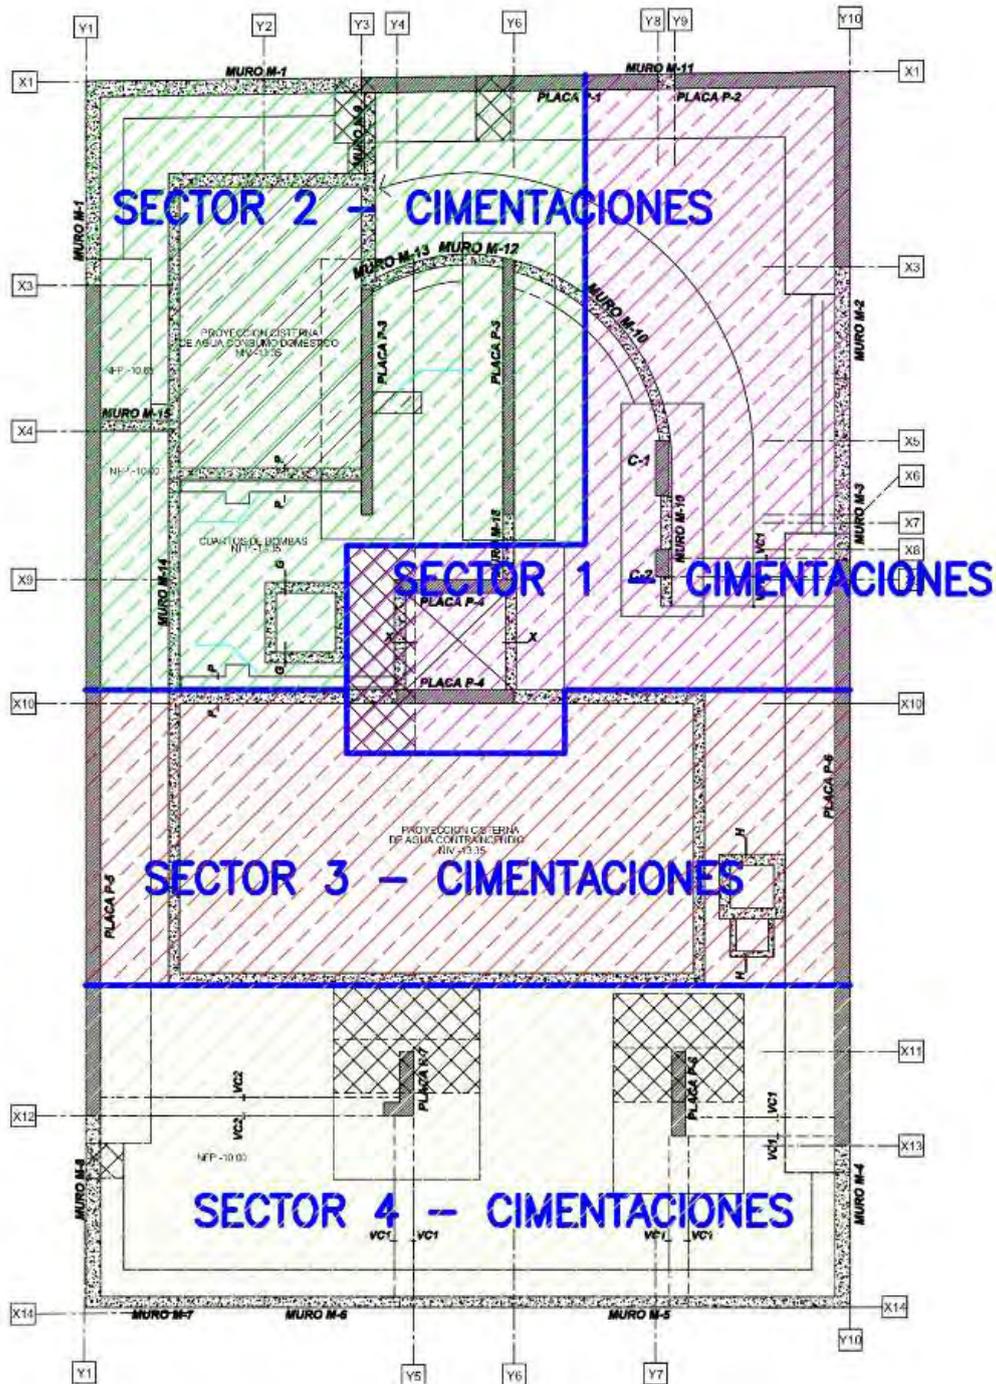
Sectorización de las cimentaciones para la construcción del proyecto.
